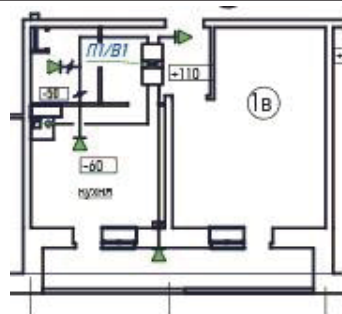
Фрагмент плана многоэтажного здания, с поквартирной системой вентиляции
